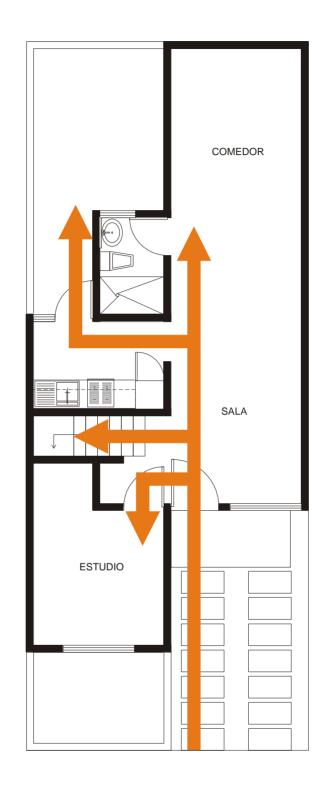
Circulación vertical y horizontal de la planta baja del prototipo de vivienda. Fuente: IGRR, 2008.
